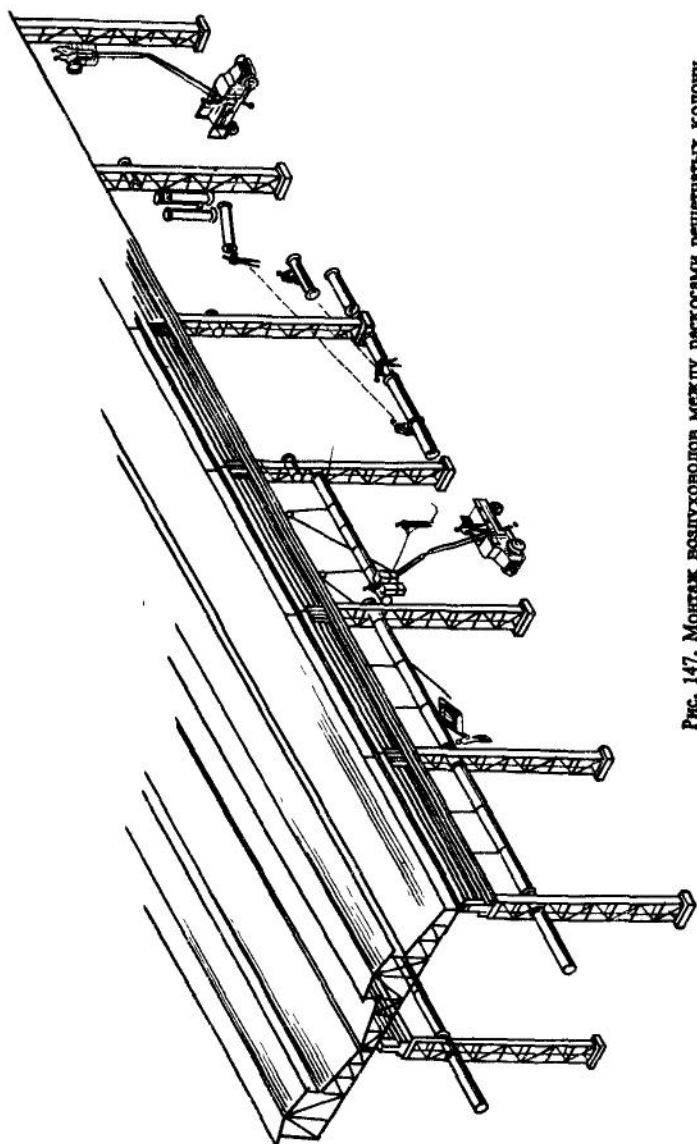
Монтаж воздуховодов между раскосами решетчатых колонн
